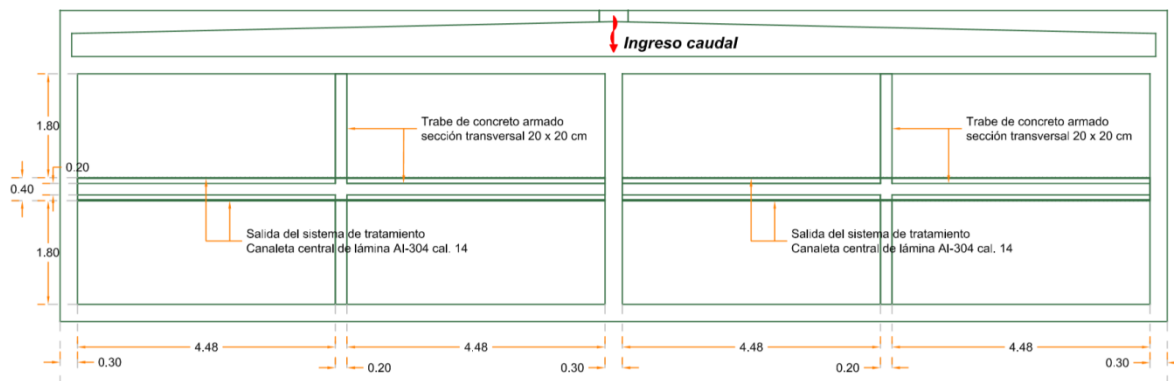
Vista en planta de canaleta de salida o efluente del sedimentador.
